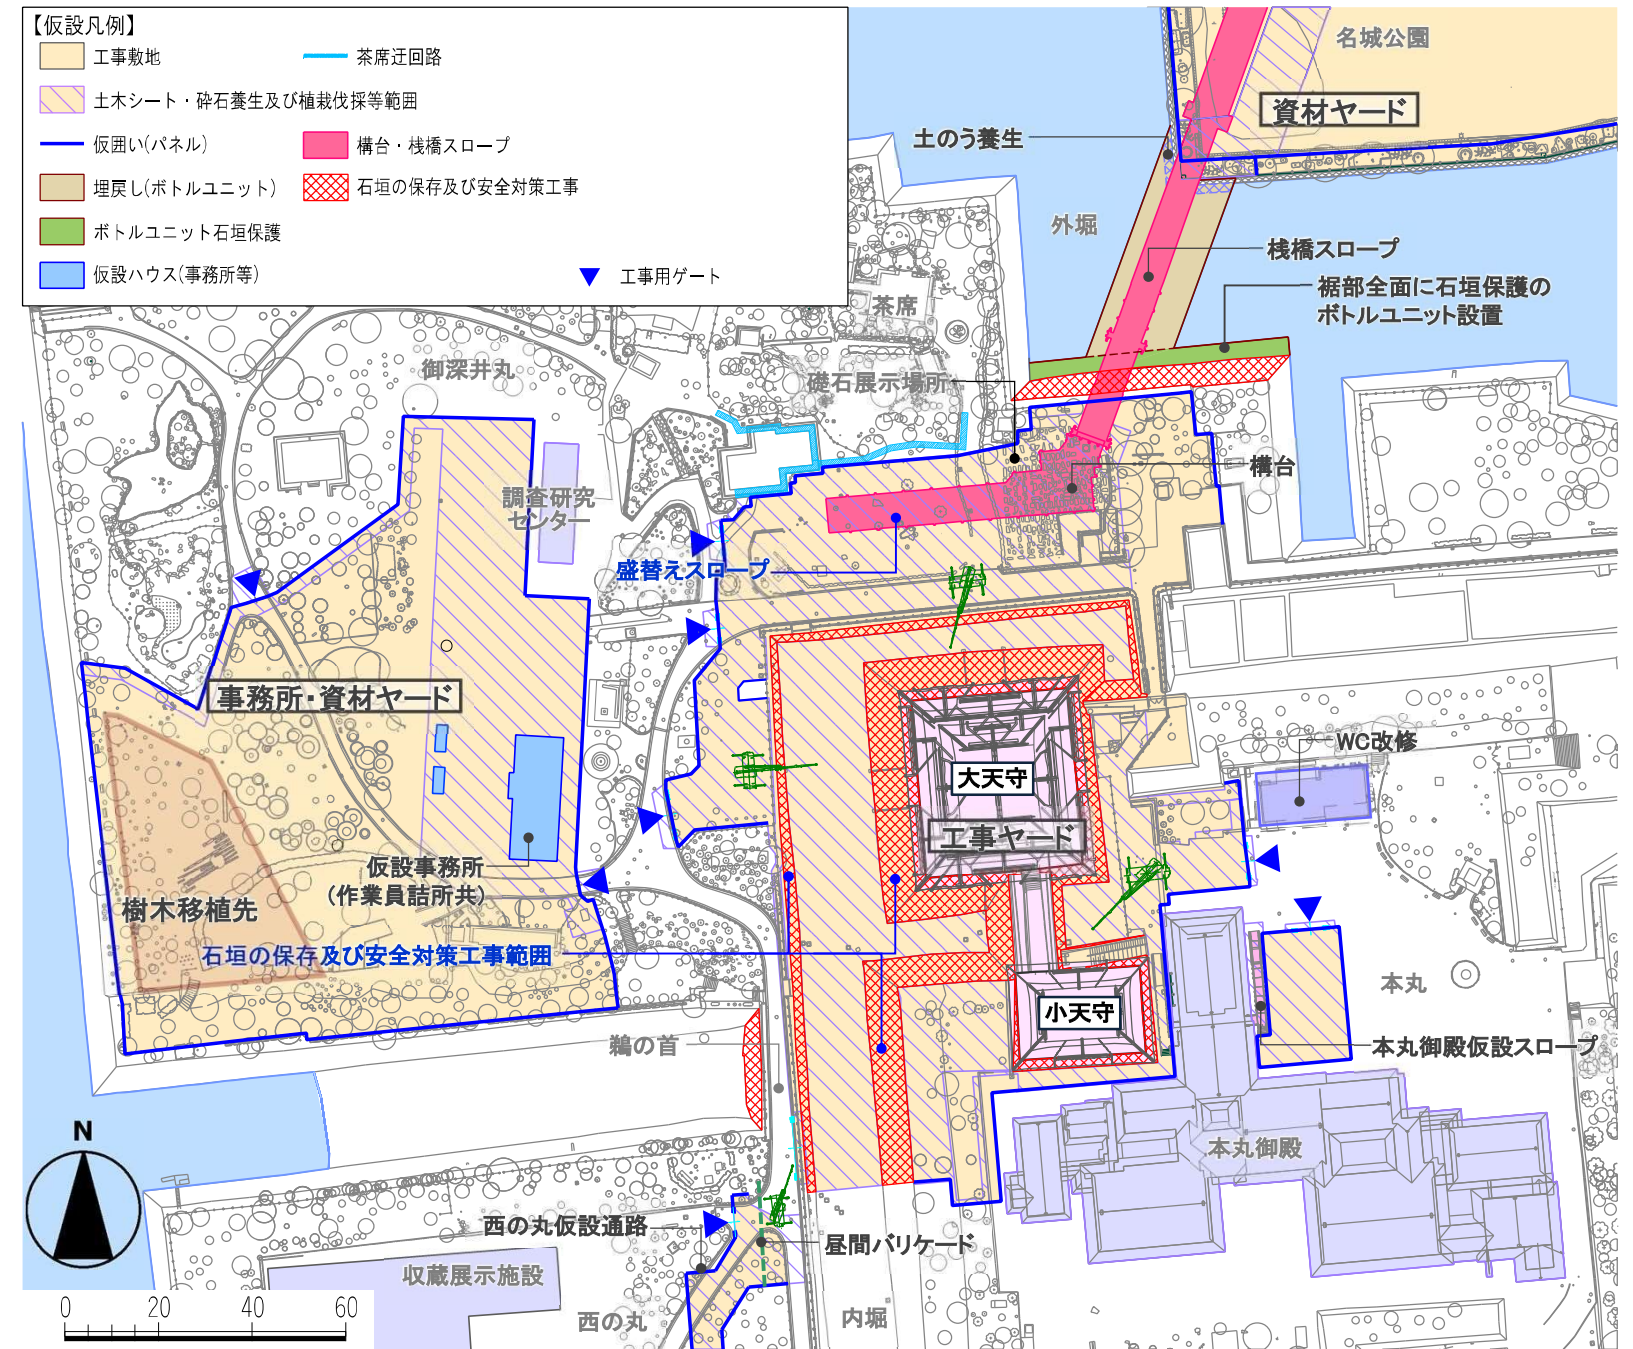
石垣の保存及び安全対策工事時の平面図
